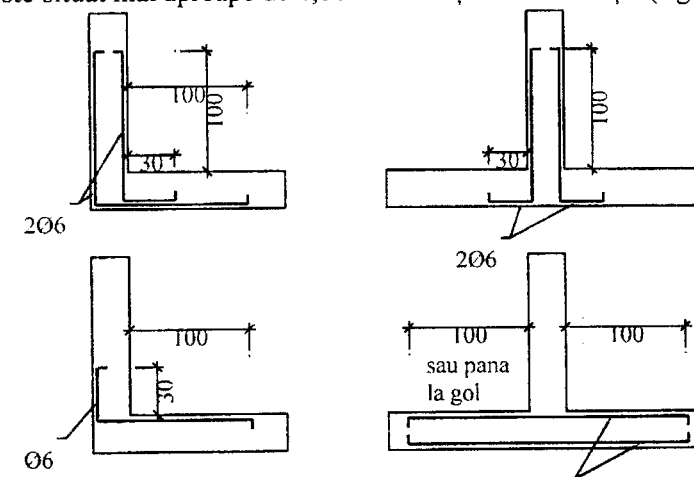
Armarea colțurilor și ramificațiilor
